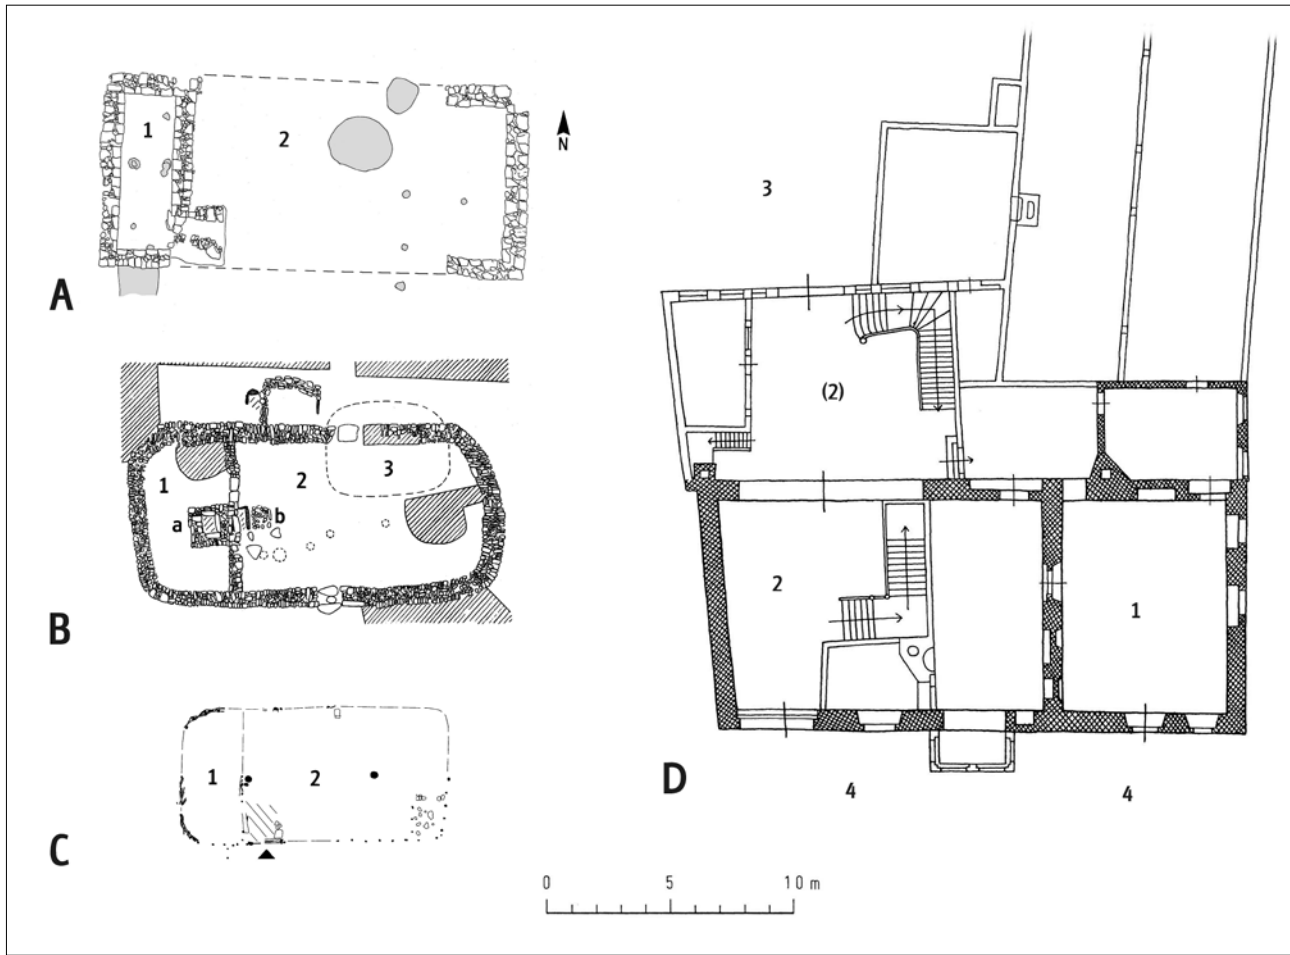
Mittelalterliche bzw. frühneuzeitliche Hausgrundrisse vom „Ernhaus-Schema“. A: Gebäude zu Steinkeller XXVI in der Wüstung Marsleben; B: Hausgrundriss in der Wüstung Hohenrode; C: Grundriss eines Flechtwerk-wandgebäudes in Einbeck; D: Haus mit Keme-nate in Braunschweig, Fallersleber Straße 8.
